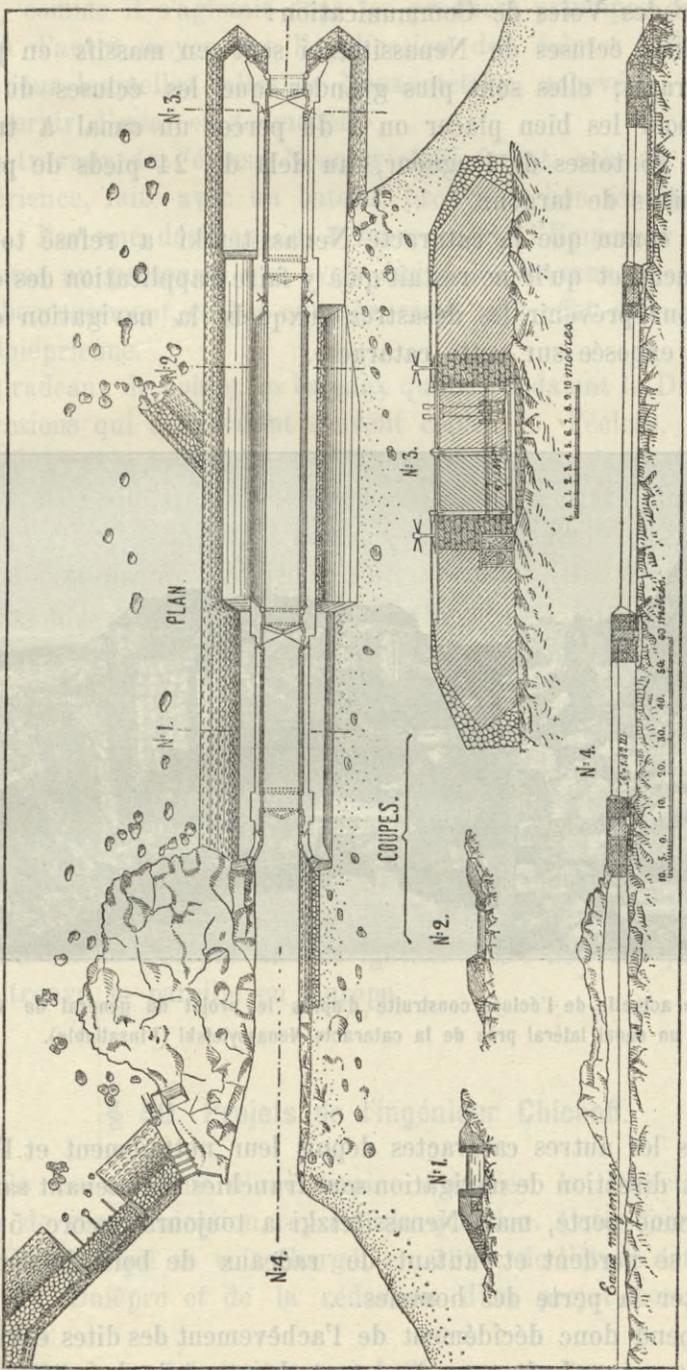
, 38, 39, 40, 41. — Plan et coupe de l'écluse de l'insatiable exécutée d'après le projet du général de Wollant.
